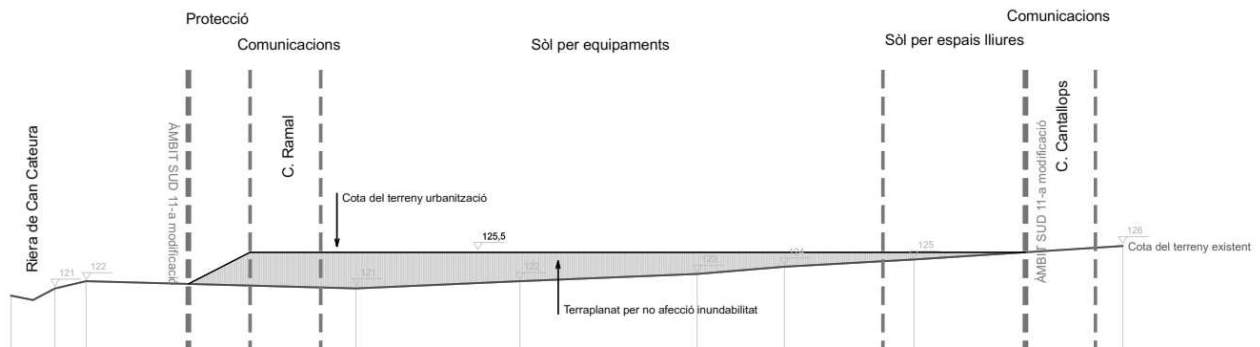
Secció del subàmbit 1 – implantació en el terreny respecte la riera de la Gotarra.
